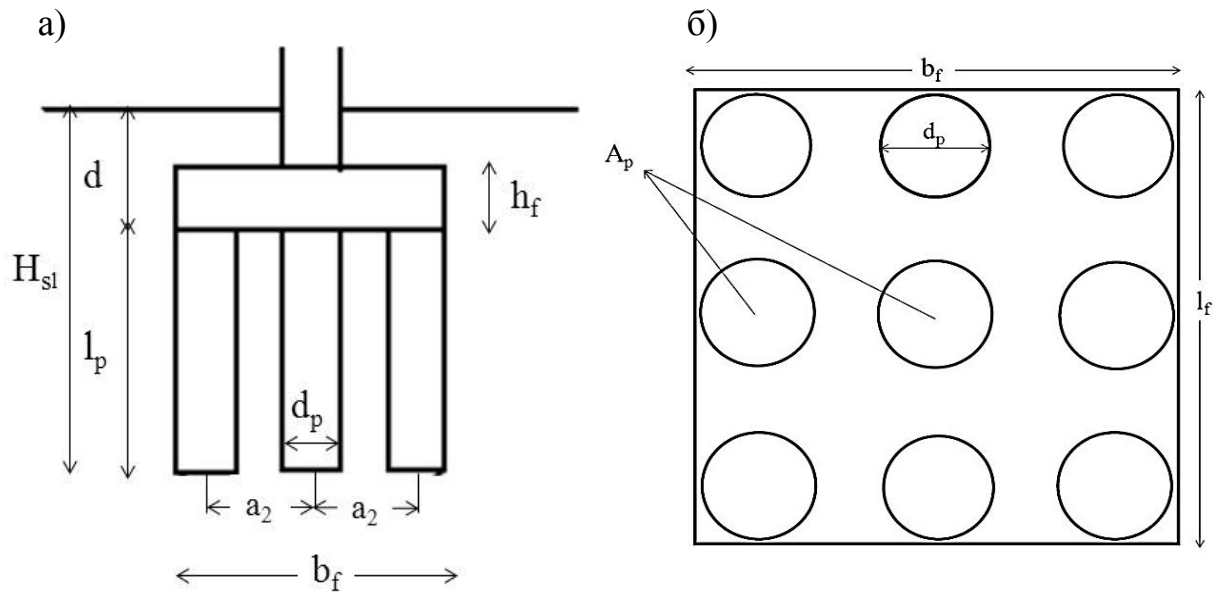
Розрахункова схема закріпленої основи: розріз (а); план (б)
